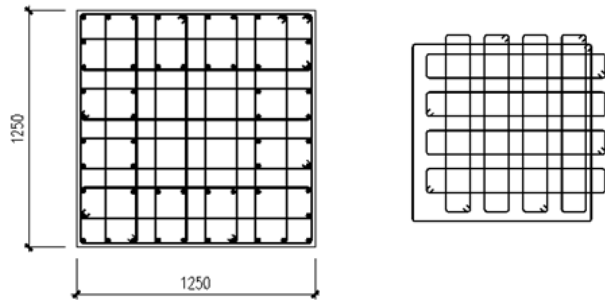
高塔典型柱首层配筋断面示意图（单位：mm）
